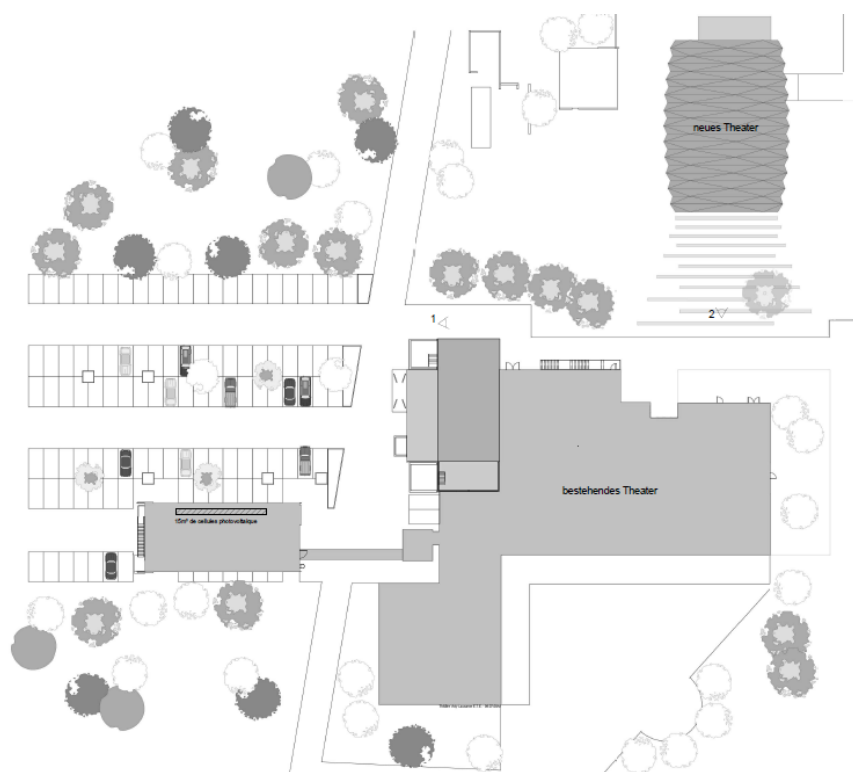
Situationsplan Théâtre de Vidy mit bestehendem und neuem Gebäude
